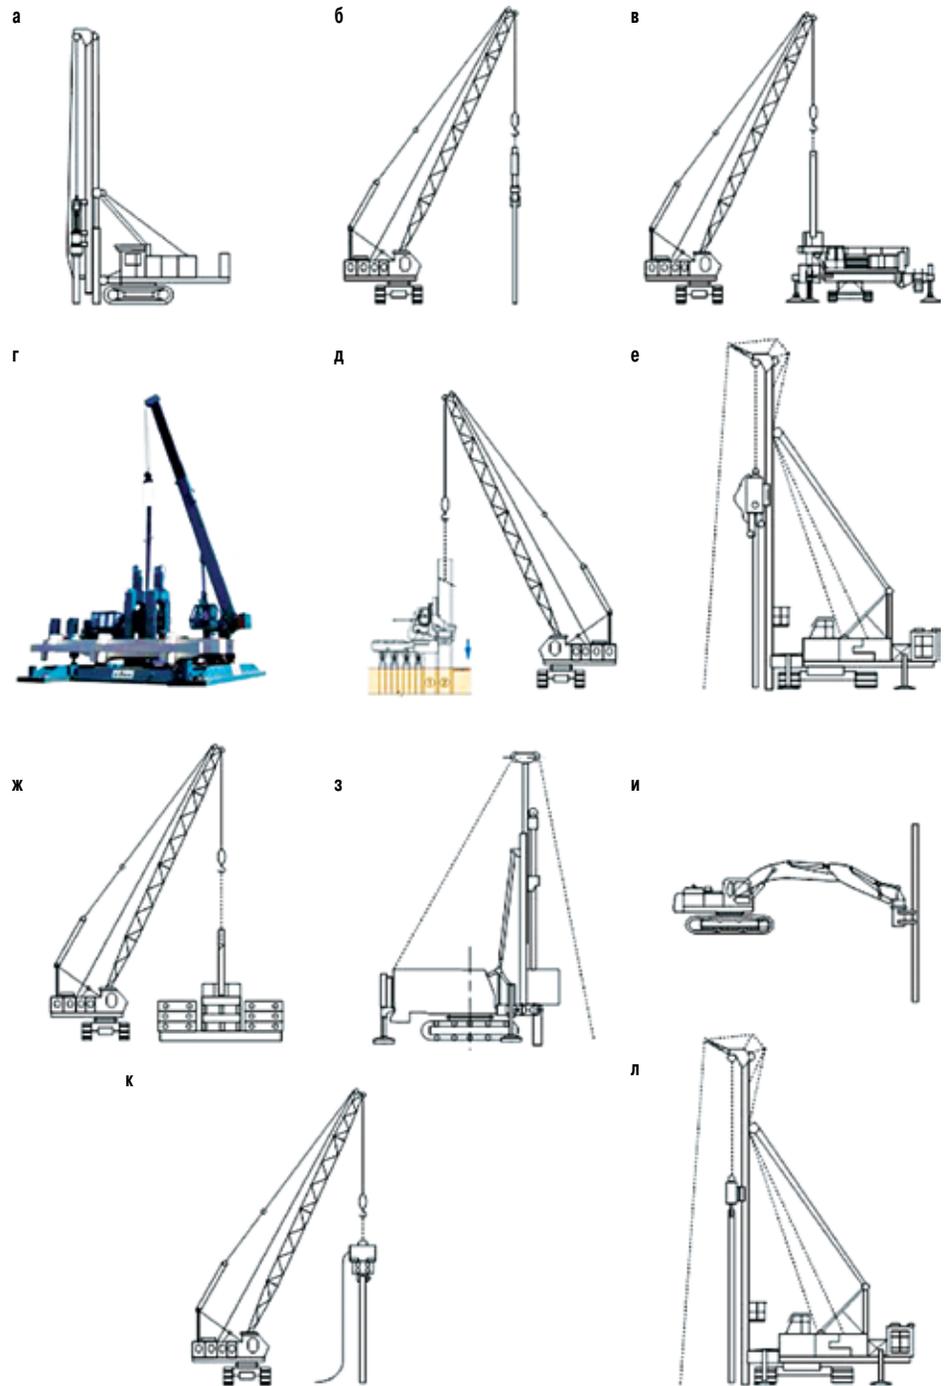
Технологические схемы оборудования для погружения шпунта: а – копер с гидравлическим молотом; б – дизельный молот, установленный на кране; в, г, д, е, ж, з – вдавливание самоходной установкой типа УСВ-120 на базе экскаватора, шагающей установкой, машинами, перемещающимися по шпунтовому ряду, системой, смонтированной на буровой установке, стационарными машинами, а также установкой на базе гусеничного крана; и, к, л – вибрационные машины, установленные на рукояти экскаватора, кране и мачте буровой установки.
